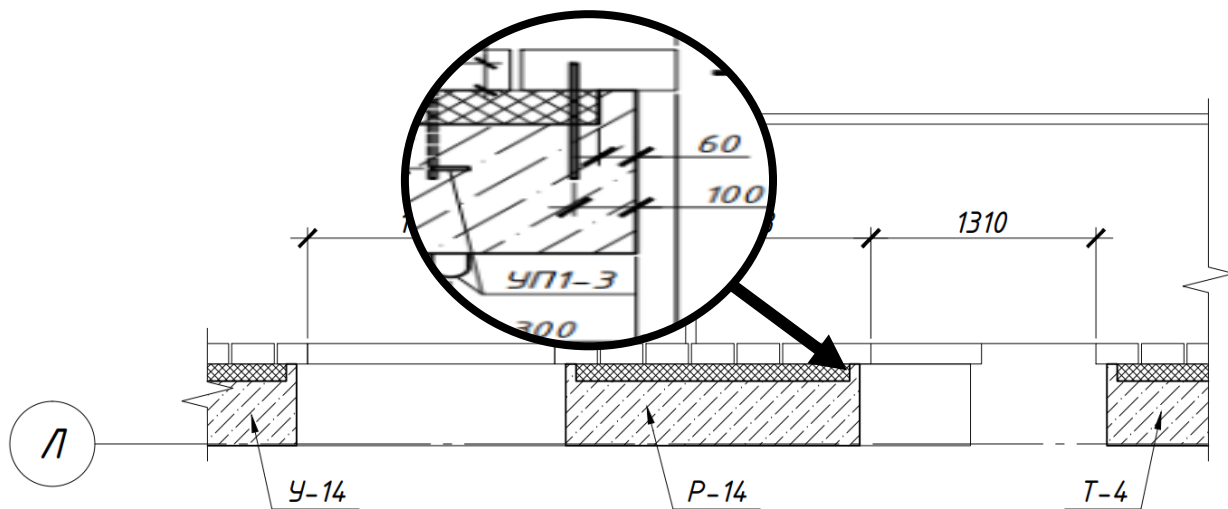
Кладочный план типового поверху розглянутої будівлі
